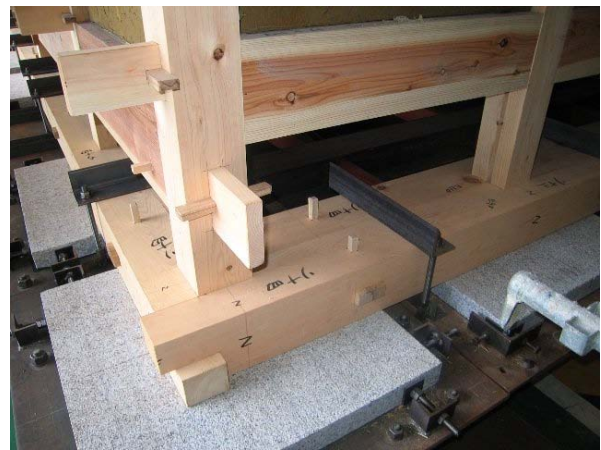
1-3 試験体 No. 6 柱脚（石場建て地長押）
